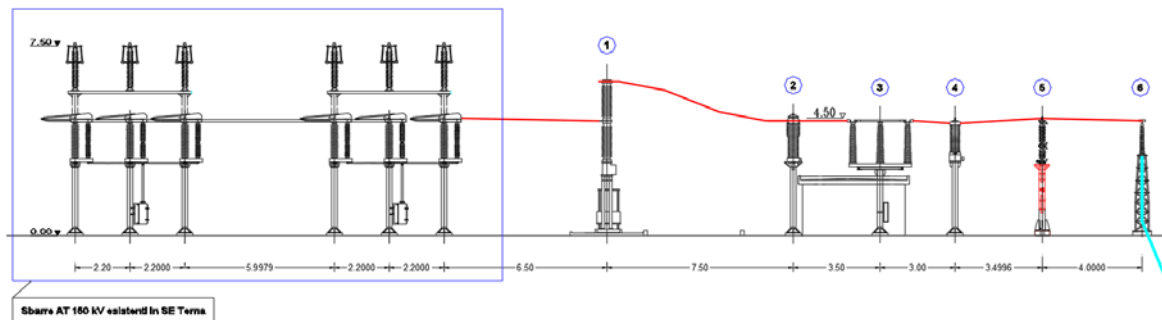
LAYOUT APPARECCHIATURE STAZIONE TERNA
